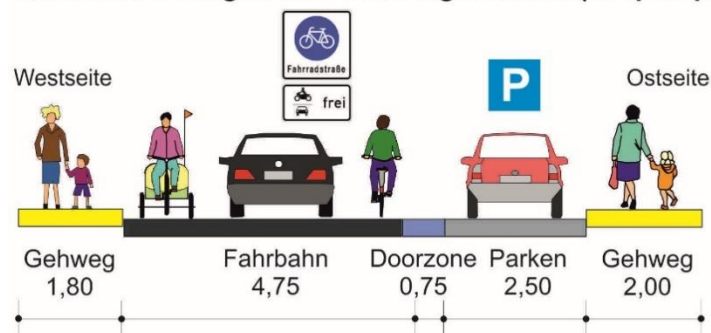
Bestandssituation und Planungsentwurf Bergstraße – Münzstraße
